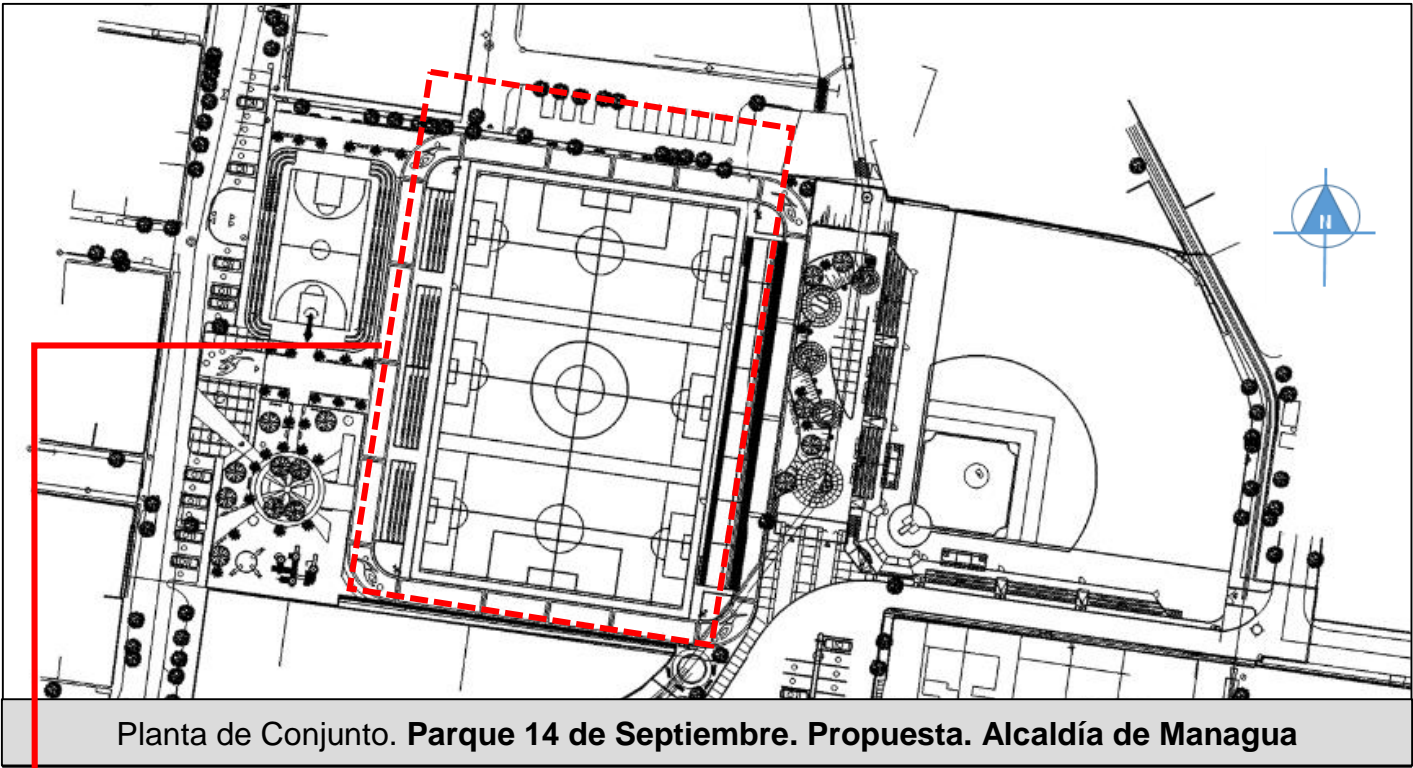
Etapa 2. Planta Arquitectónica del Estadio de Futbol
